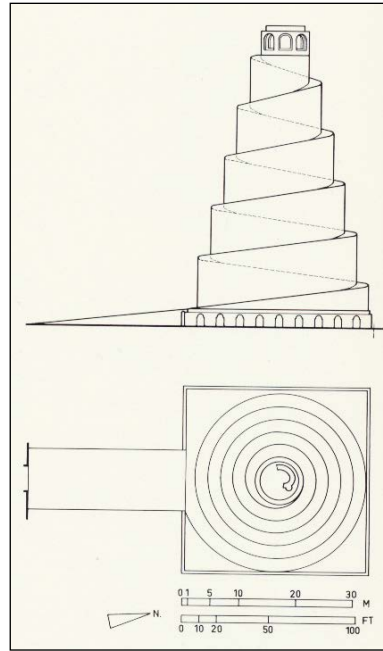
Samarra, Irak, Grundriss und Ansicht des Minarett
